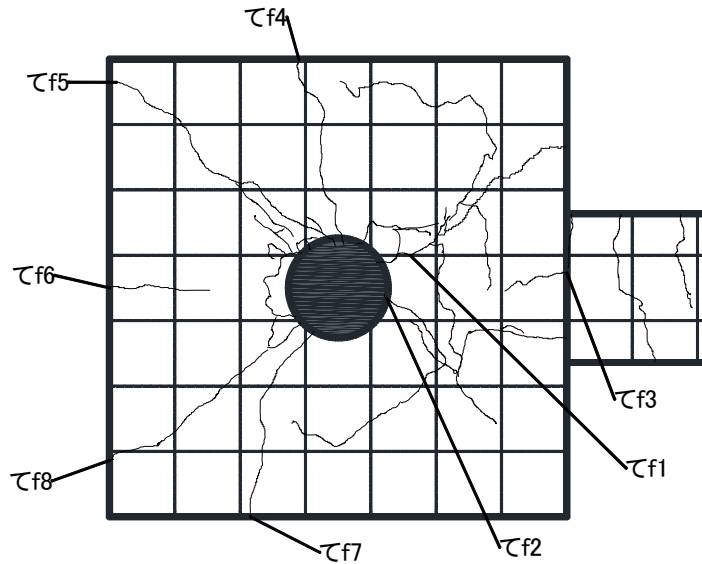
2. 3-101 パイルキャップ底面ひび割れ幅測定位置 (試験体 DR-4 +7.0 サイクル)
